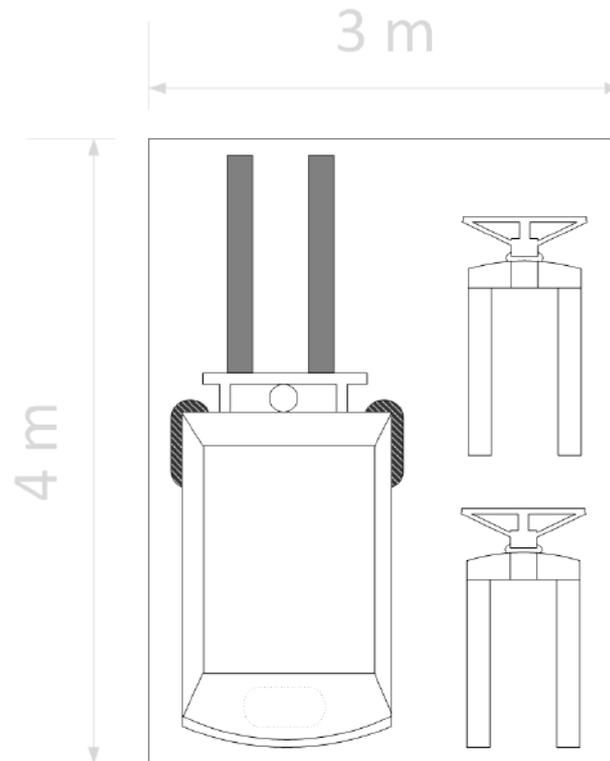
Zonificación propuesta del área de EMM en Planta Baja
